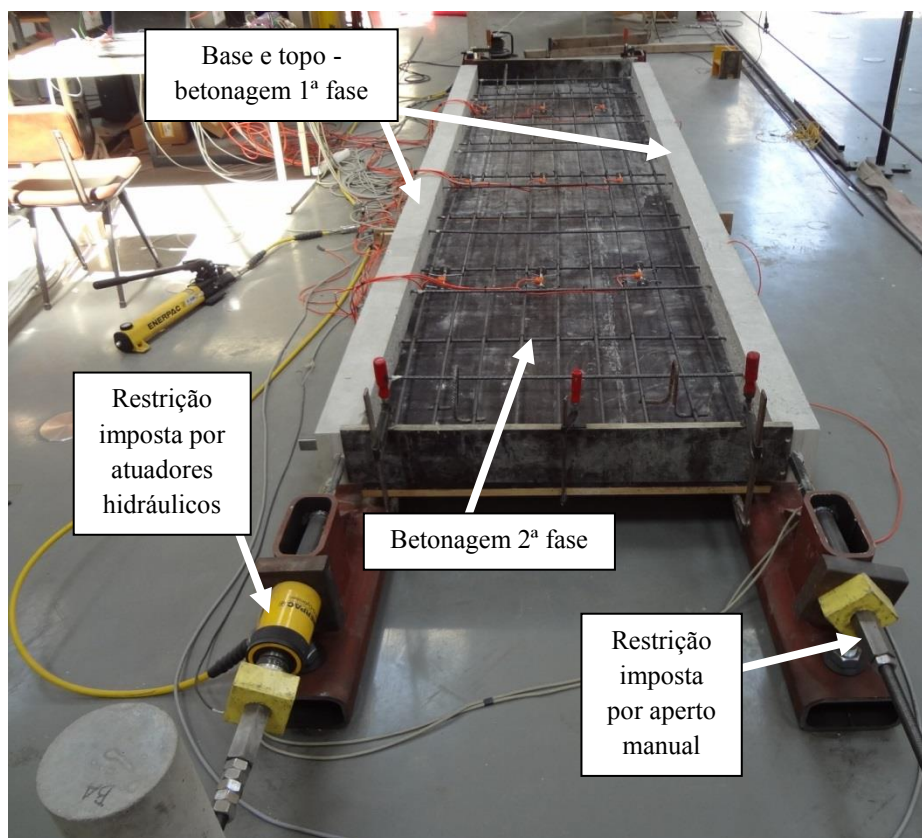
Vista geral da estrutura laminar após betonagem da 1ª fase.
